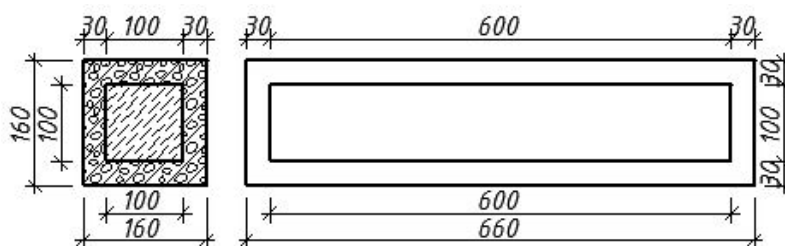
Комплексна легкобетонна балка без посилення (Б-1)
